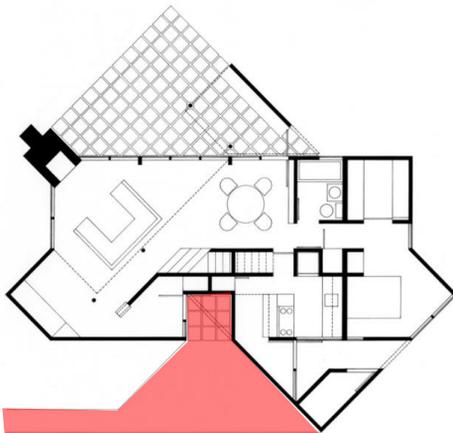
Planta Baja Casa Hoffman Consultada en: <http://www.richardmeier.com/?projects=hoffman-house>
